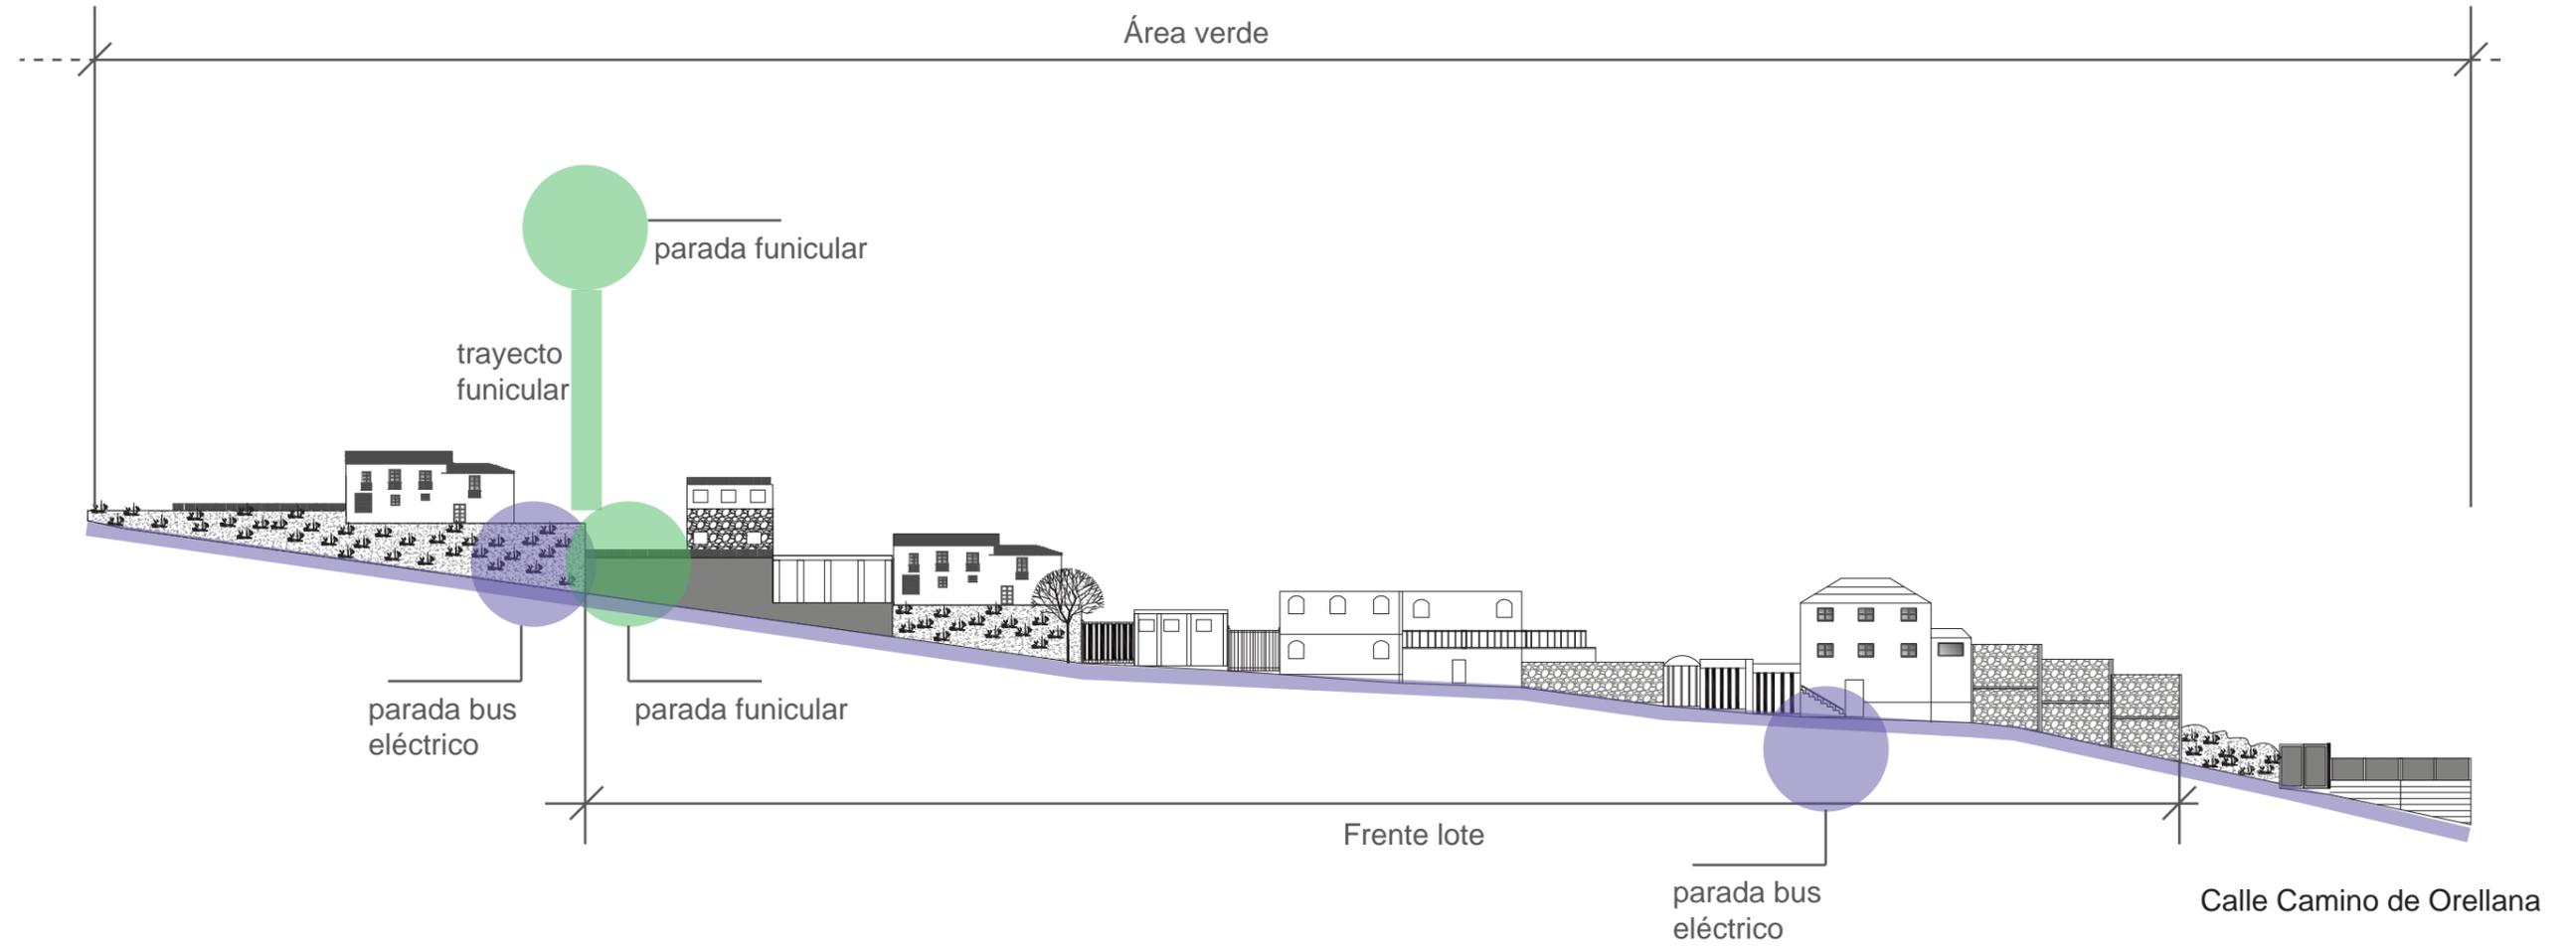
Levantamiento de fachadas lote y entorno inmediato.
